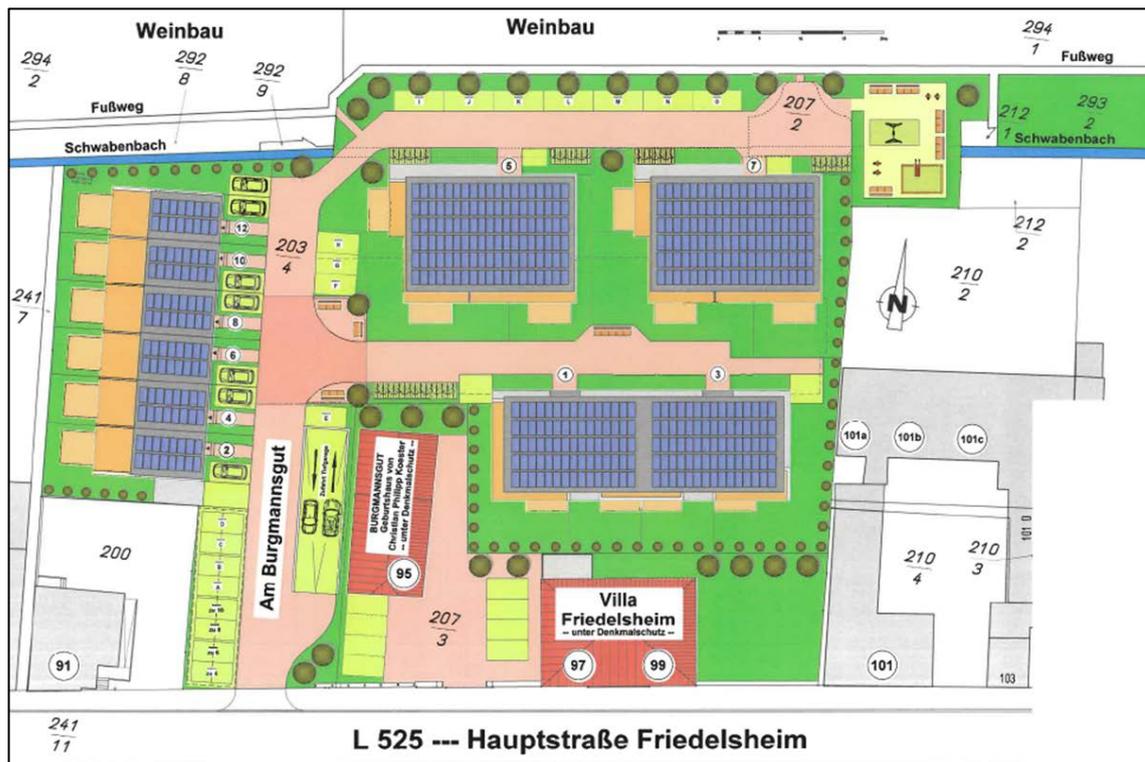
Lageplan der geplanten Gebäude, Auszug aus Plansatz Planung [2]
